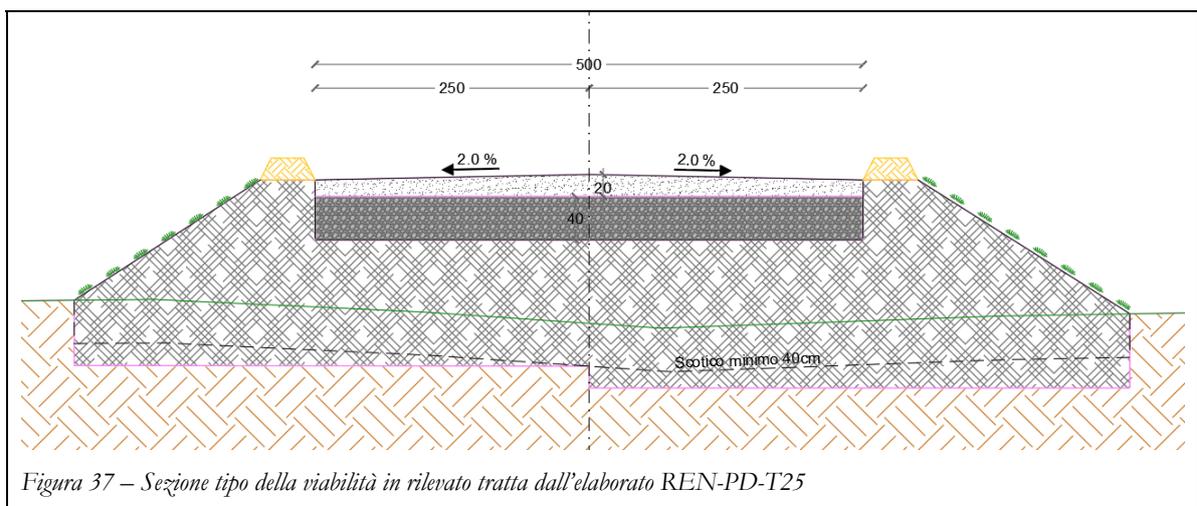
Sezione tipo della viabilità in rilevato tratta dall'elaborato REN-PD-T25
